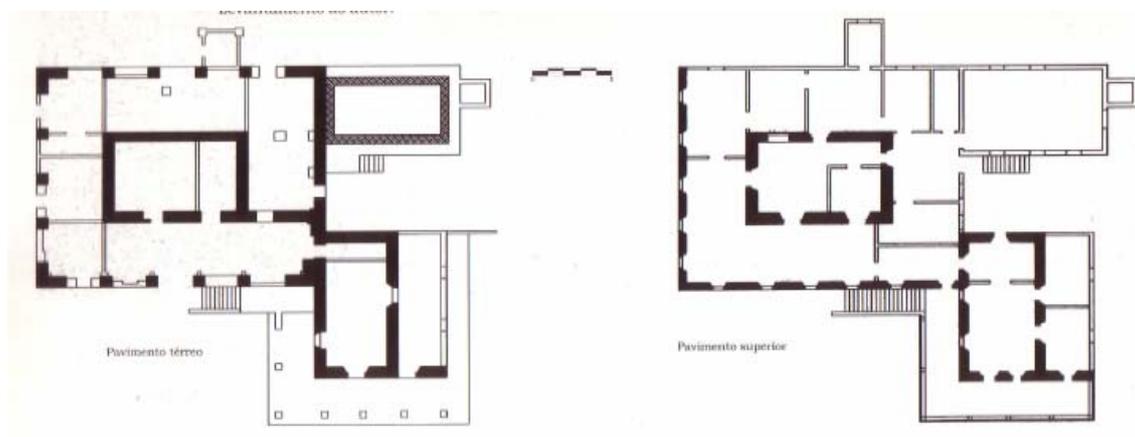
Plantas Baixas da Casa Grande do Engenho Gurjaú-de-Cima, em Cabo de Santo Agostinho -PE
